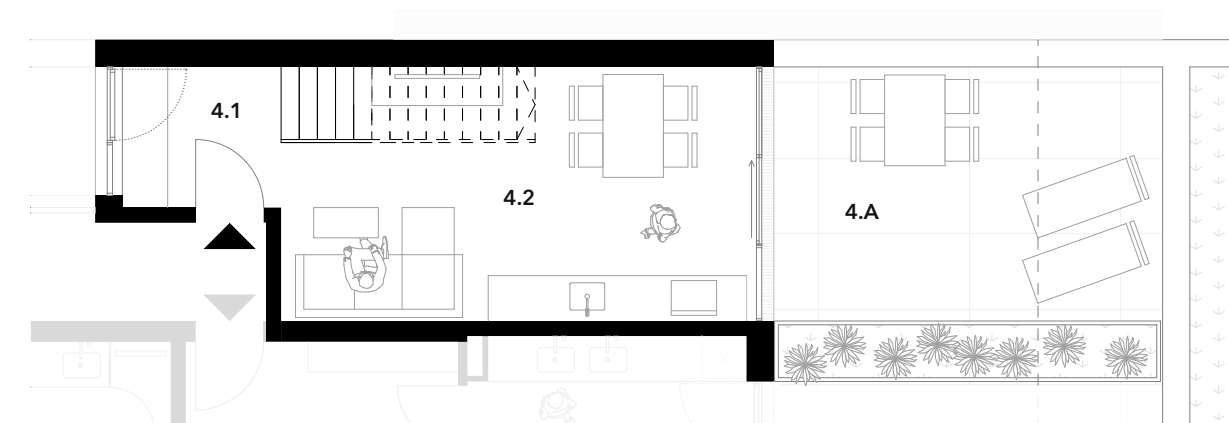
Grundriss Untergeschoß TOP 4
